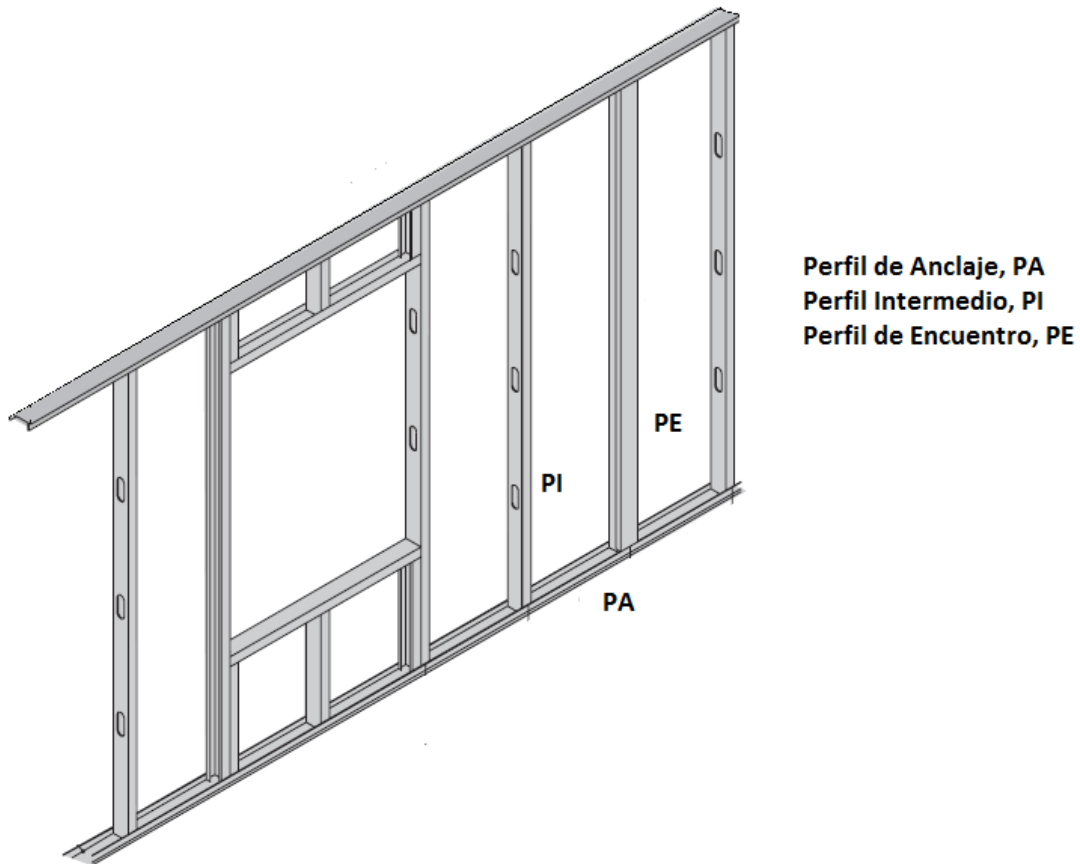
Disposición de los elementos de acero en el entramado. [87]
